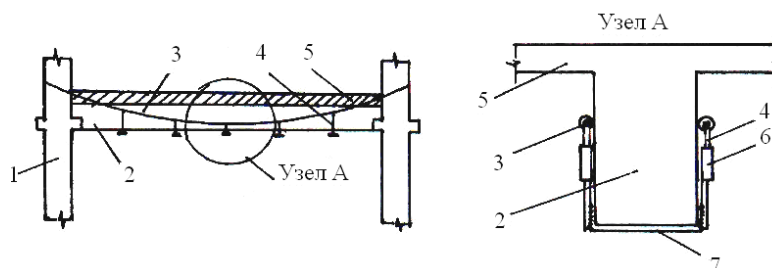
Усиление балок монолитного перекрытия шпренгелем
